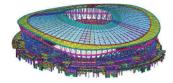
钢结构深化设计 Fig. 8 Detailed design of steel structure
